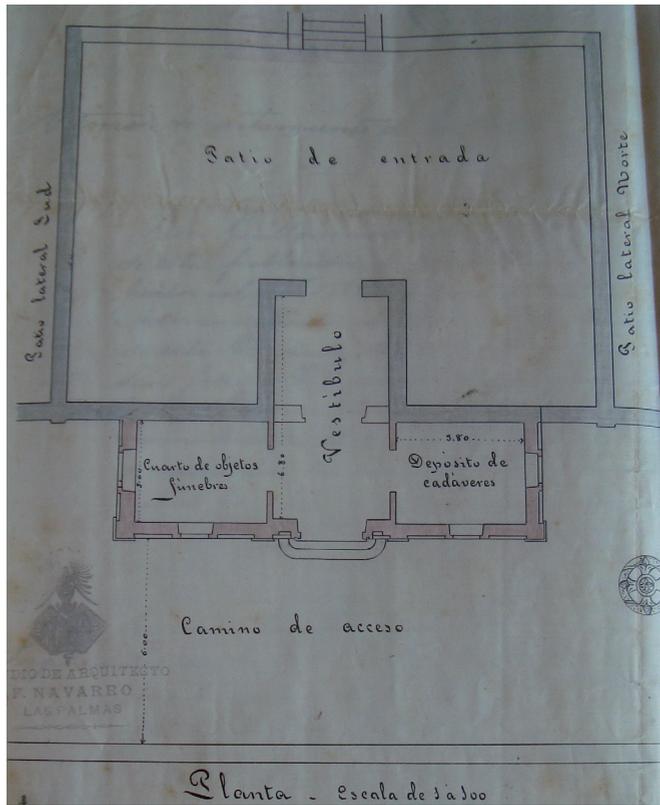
Planta del proyecto de cuerpo exterior de ampliación del cementerio. 1904.
